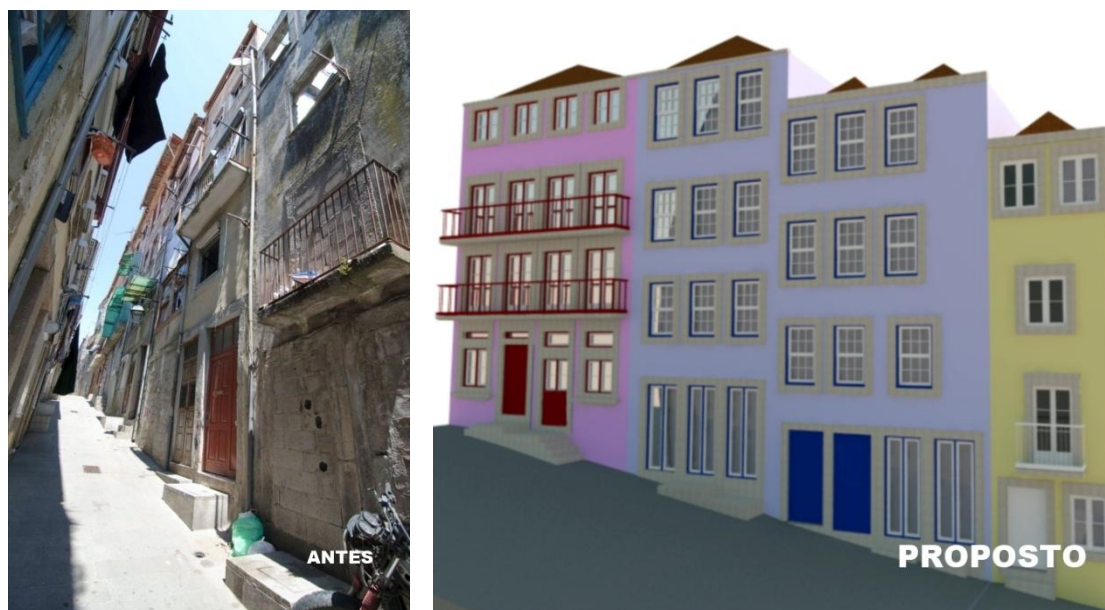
Proposta para a fachada principal da Operação H - Projeto 14 - Fonte: Site da Porto Vivo, SRU
